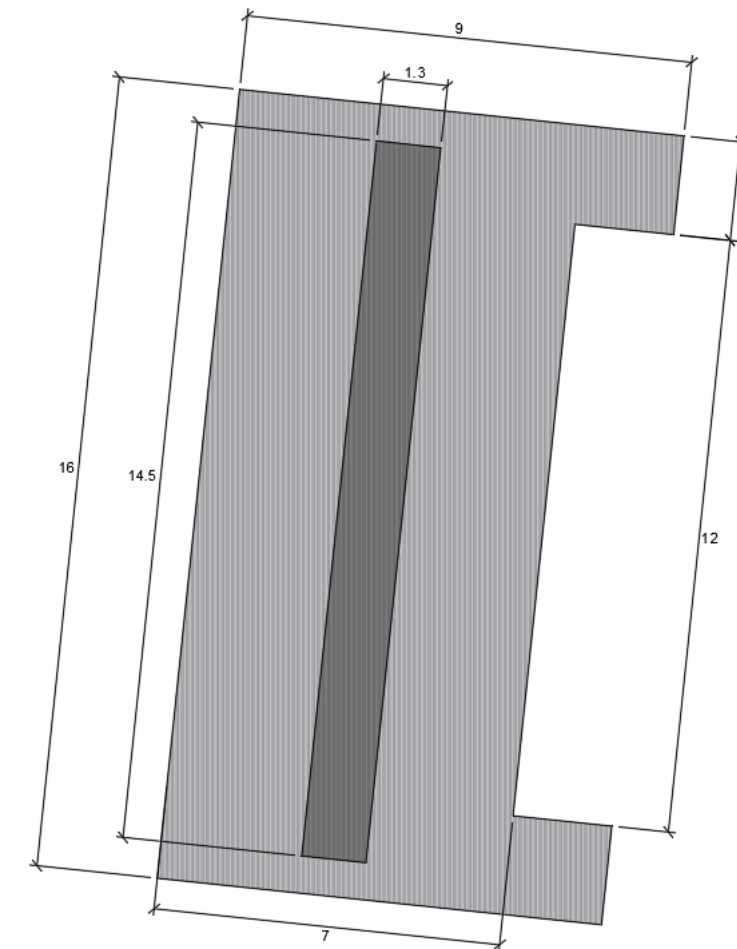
Vista en planta de la cimentación del Estribo Derecho
